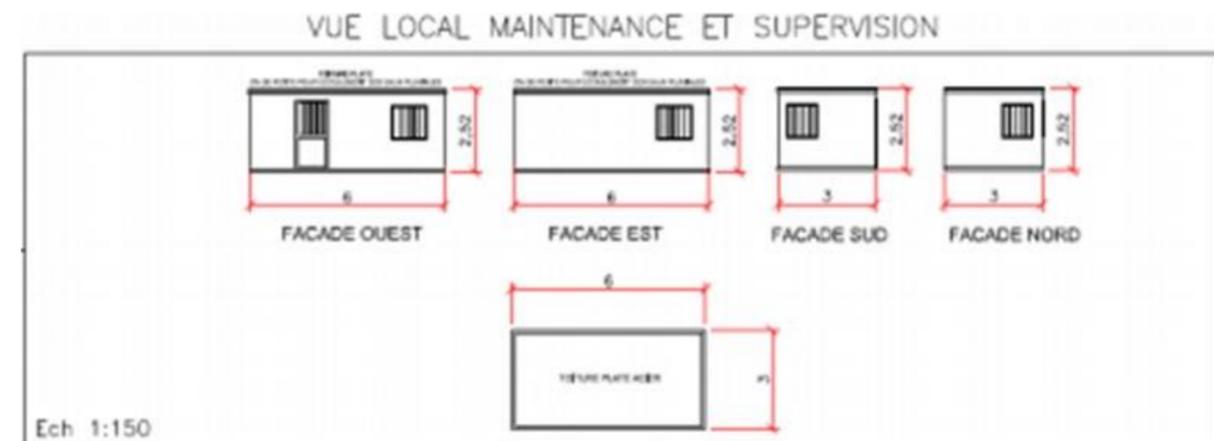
Schéma de l'extérieur d'un local supervision (source : dossier de permis de construire)
